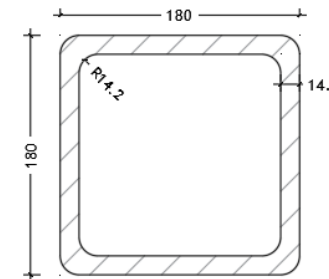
Sección Sección de las vigas en triangulación en mm.
